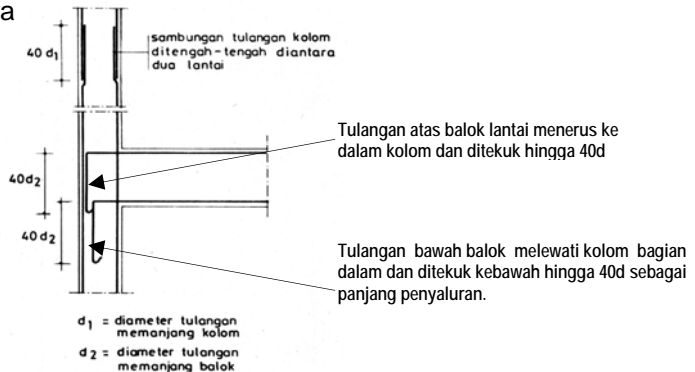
Detail A, penulangan hubungan balok ujung atas (atap) dengan balok pinggir
